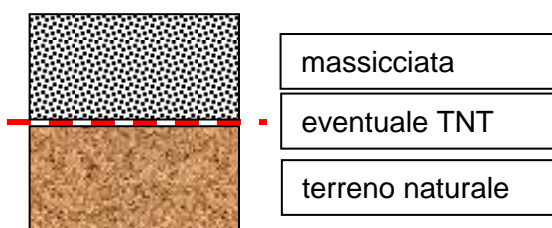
Schema di realizzazione pista di cantiere Tipo I.
